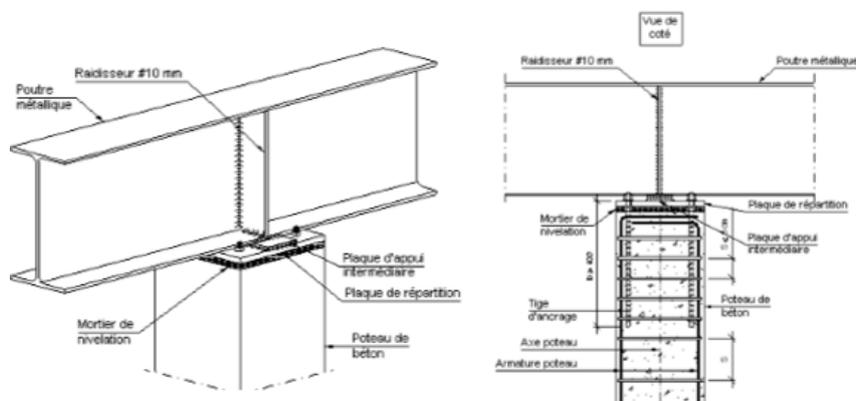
Appui d'une poutre métallique continue sur un poteau en béton
